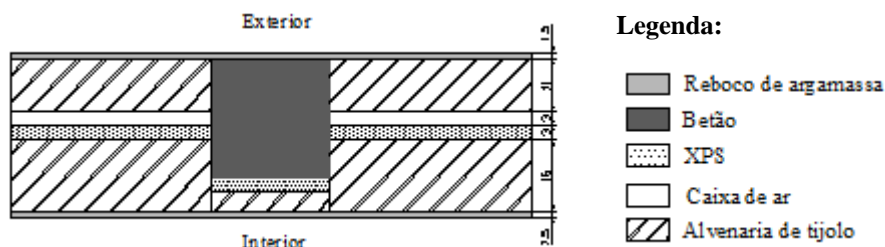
Pormenor construtivo do pilar na parede exterior revestido com XPS
